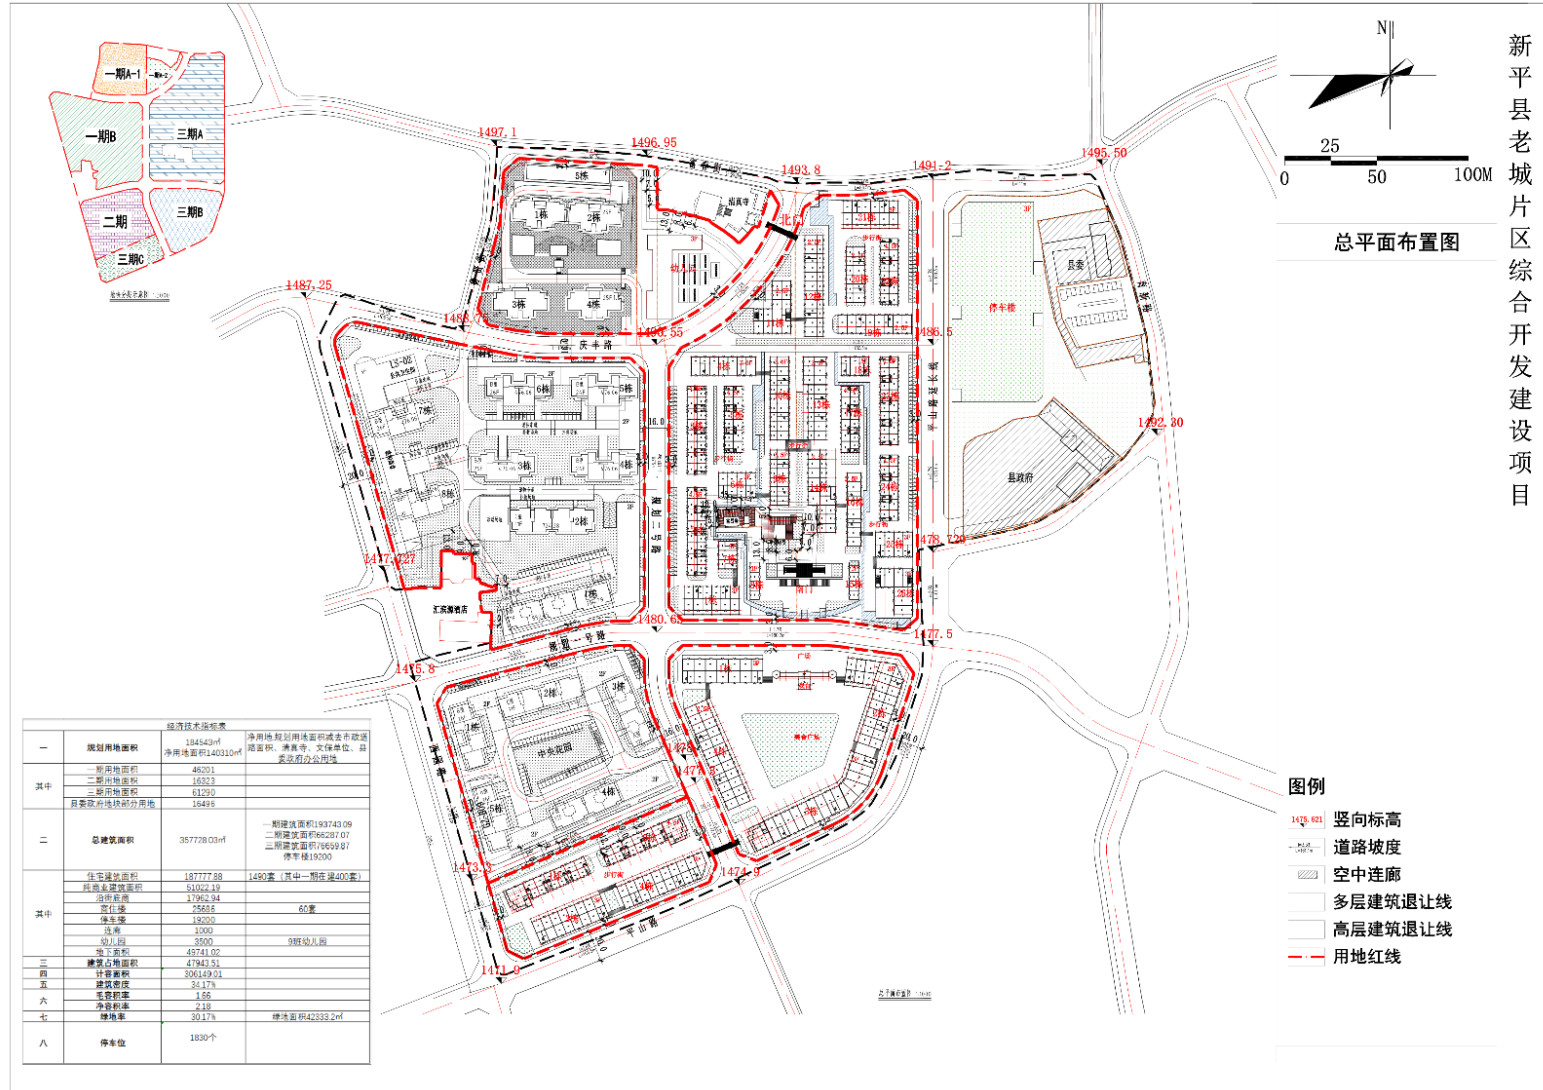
《新平县老城片区综合开发建设项目》总平面布置图
